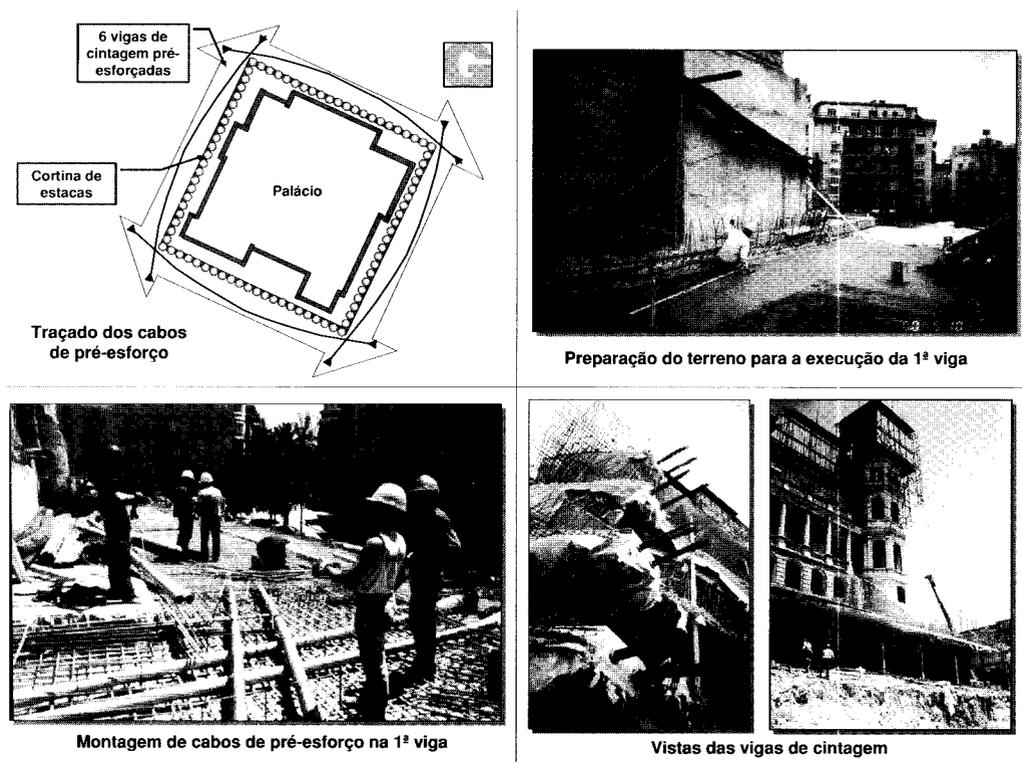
Traçado, montagem e vista das vigas de cintagem.
